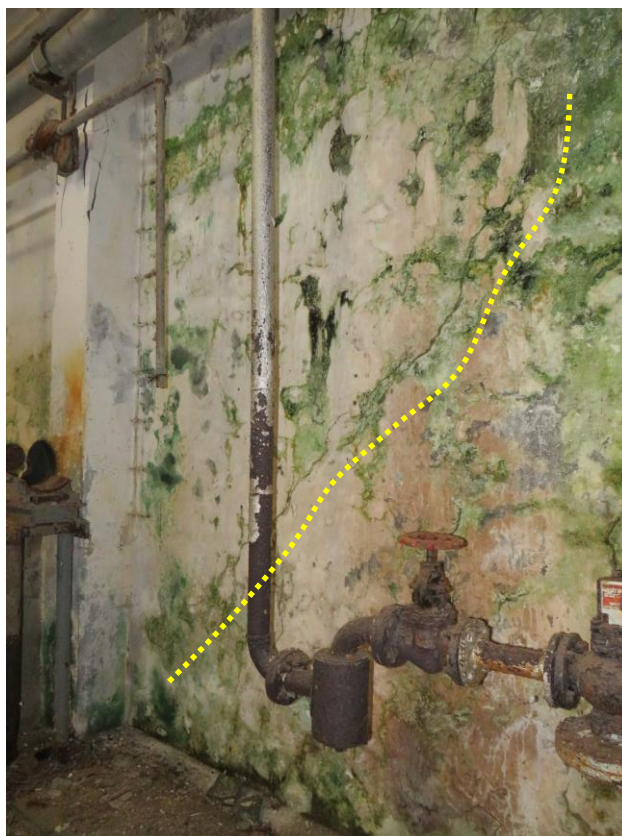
Manchas de humidade e fissura diagonal em parede Norte.
